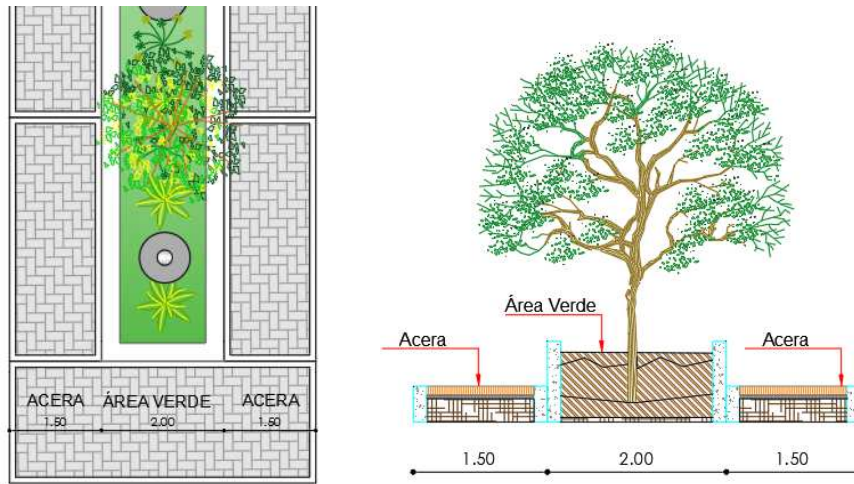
Pasaje Peatonal (Planta y Corte)
